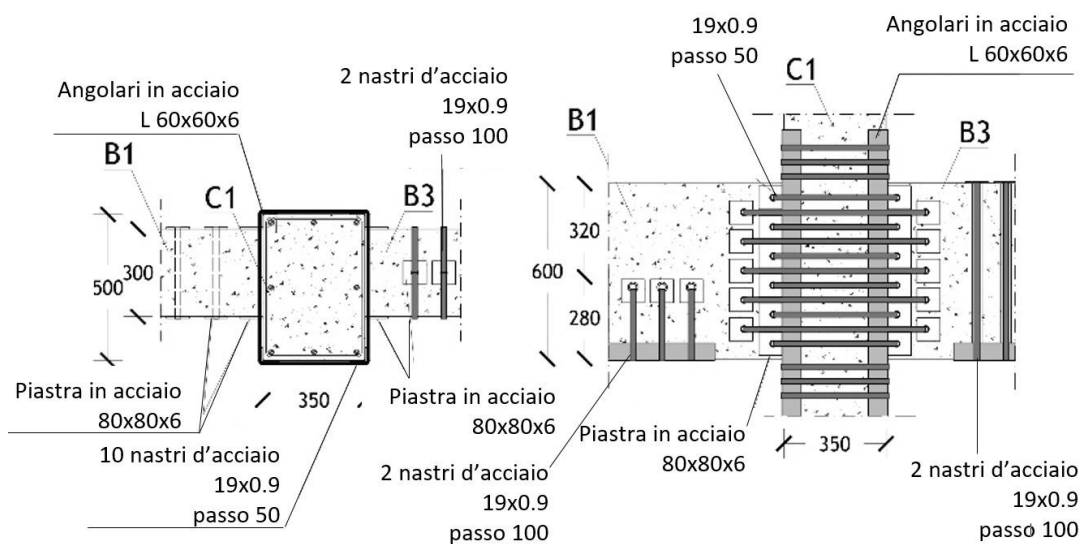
Sezione orizzontale e prospetto del nodo strutturale N rinforzato con il sistema CAM
